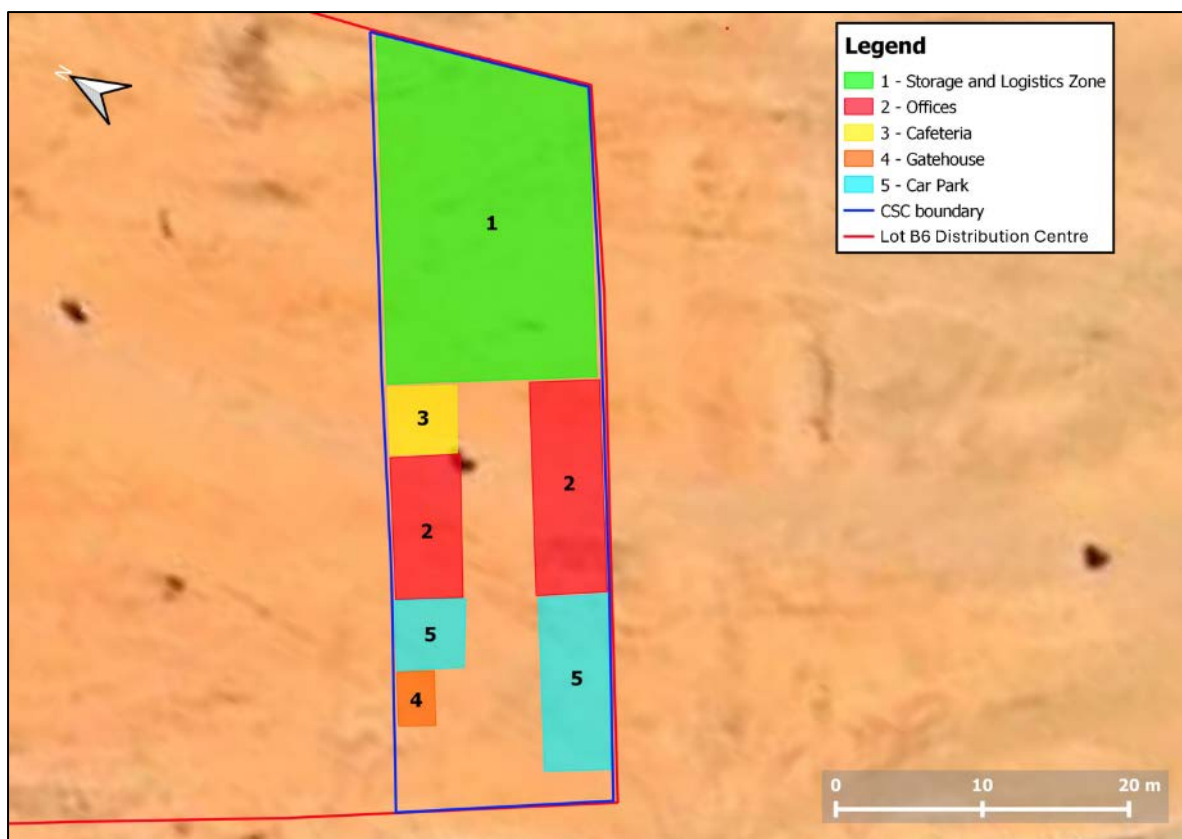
Zoneamento geral do Complexo de Apoio à Construção B6 (Fonte: CCA, 2025)
